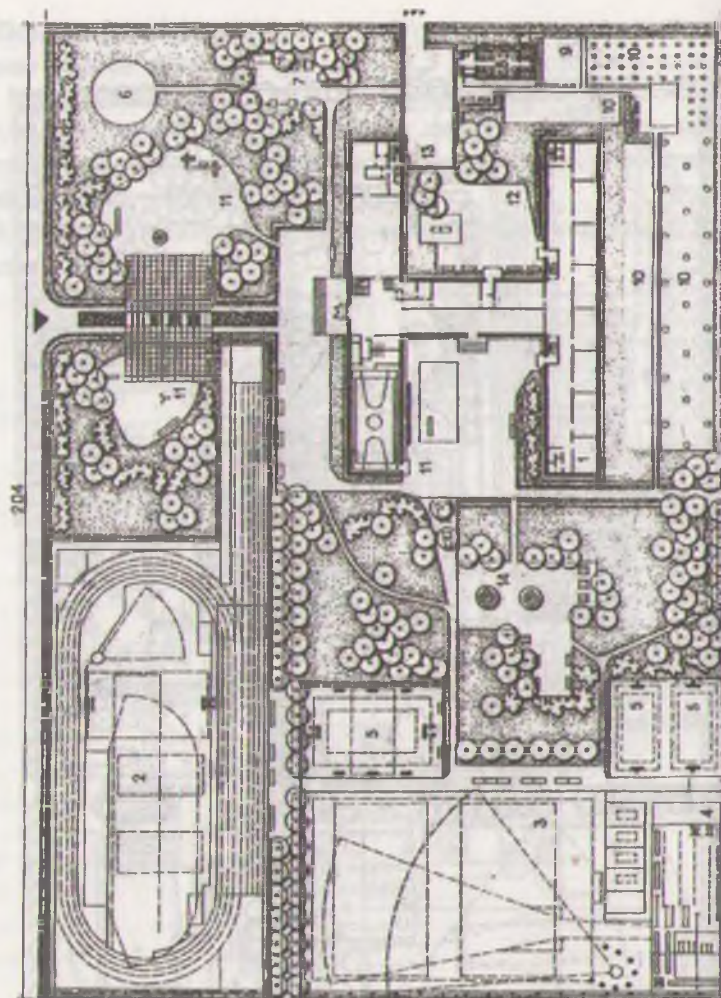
Планировка и озеленение участка школы на 1280 учащихся: 1- здание школы; 2 – площадка для легкой атлетики; 3 – площадка для спортивных игр; 4 – площадка для гимнастики; 5 – площадка для волейбола и баскетбола; 6 – метеорологическая площадка; 7 – зоологическая площадка; 8 – теплица; 9 – парники; 10 – учебные посадки и посе- вы; 11- площадка для подвижных игр младших классов; 12 – площадка для подвижных игр старших классов; 13 – хозяйственный двор; 14 – площадка тихого отдыха.
